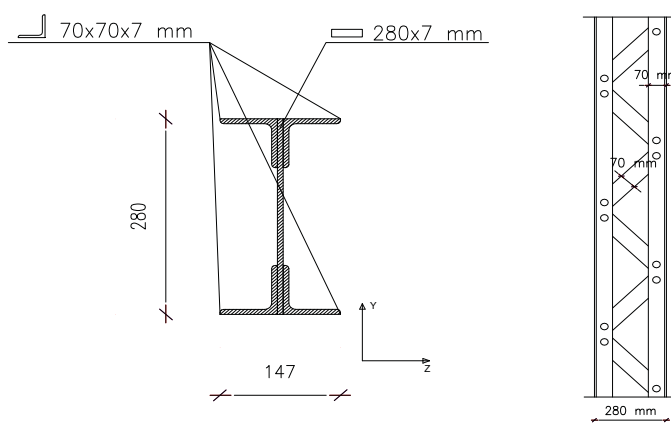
Desenhos do perfil montante 1 da ponte.
